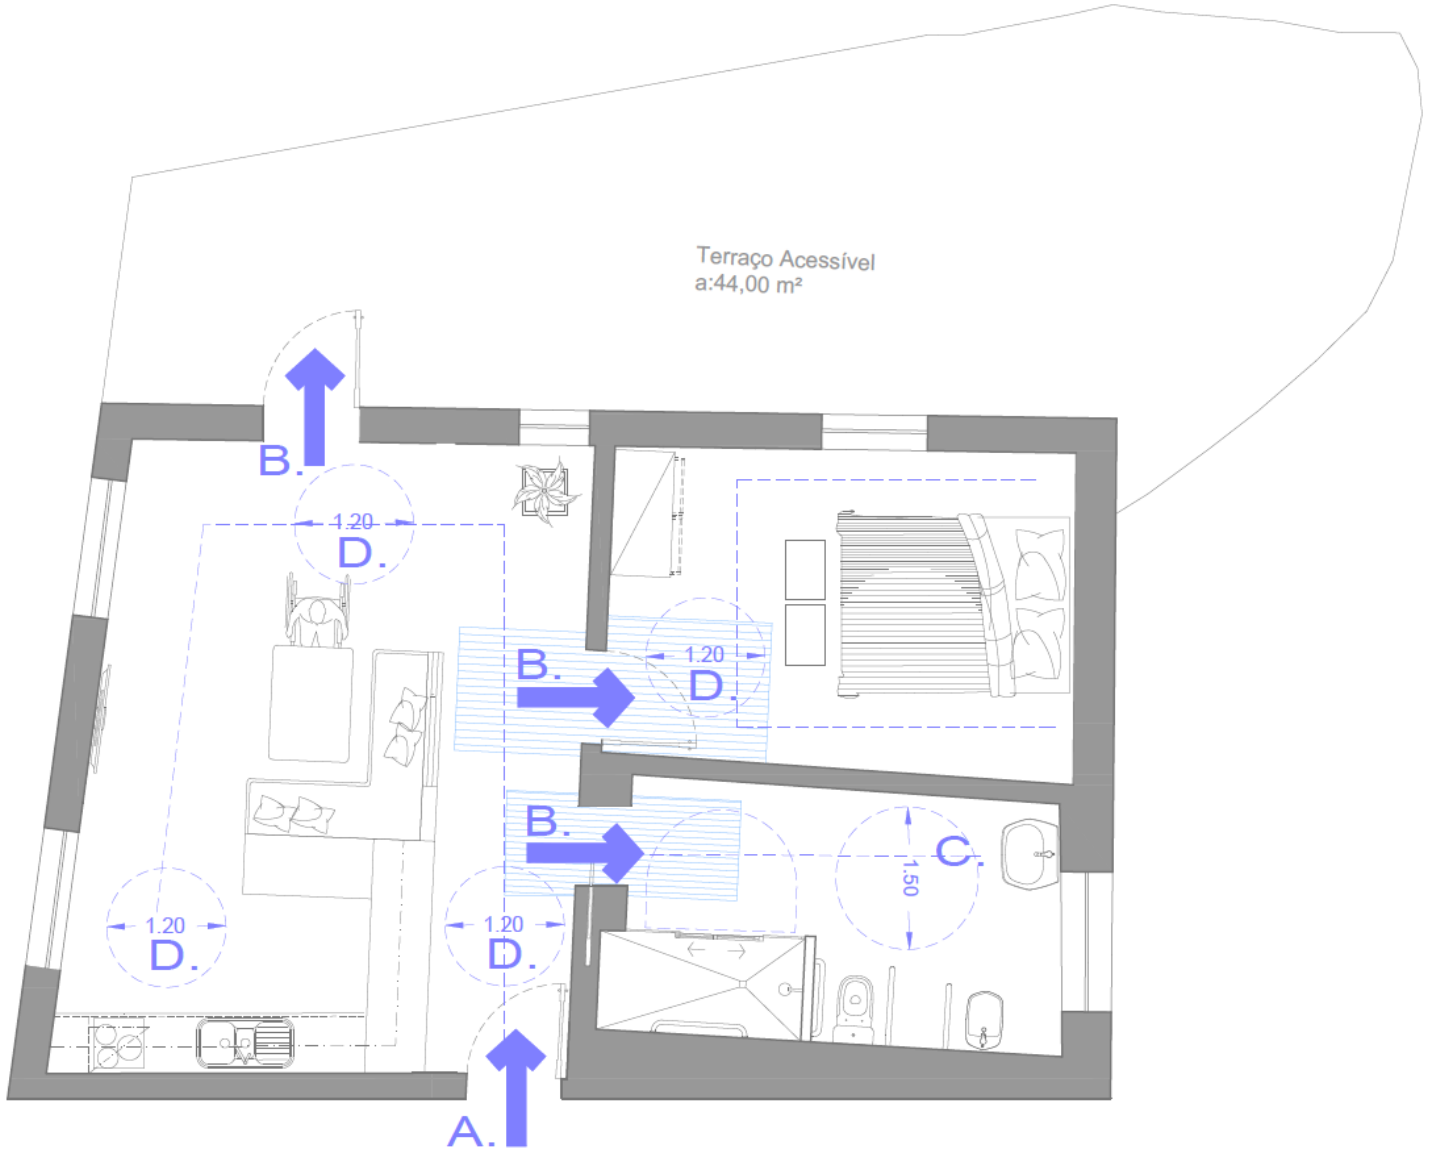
Casa 1: Planta de Acessibilidades - R/Chão. Esboço 2
